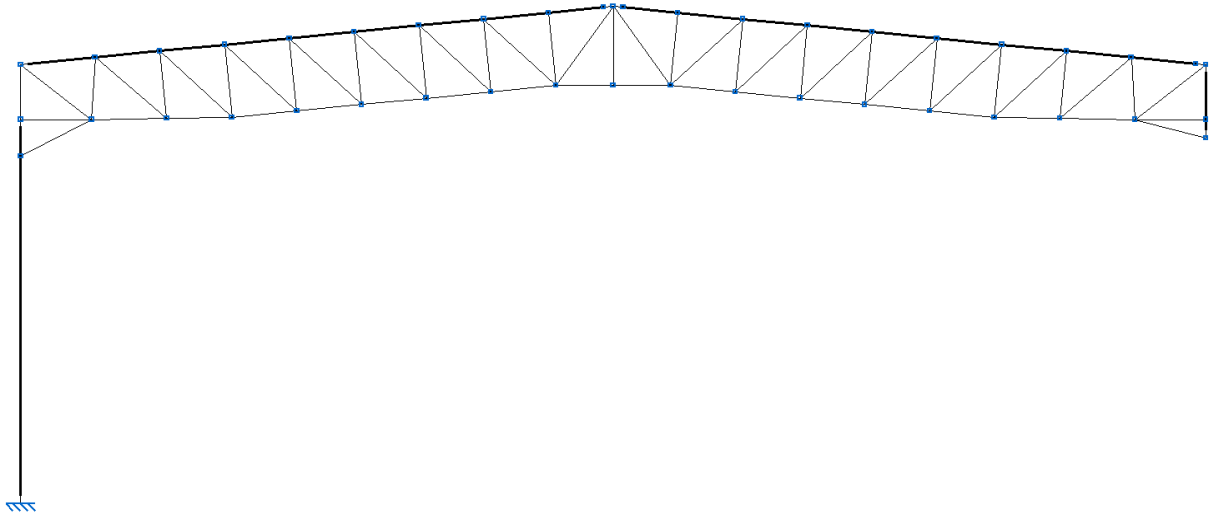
Estructura Alámbrica - Pórtico Tipo N°1. Fuente: Elaboración propia.
